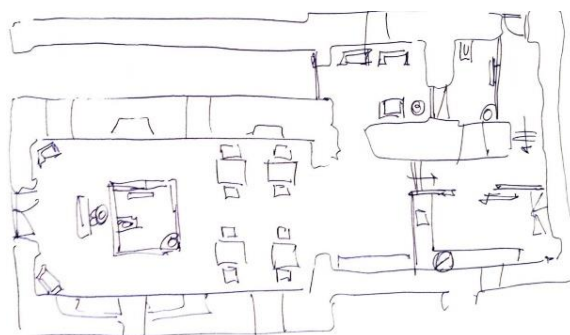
Planta de estudo; *Fonte: Mariana Vieira.
